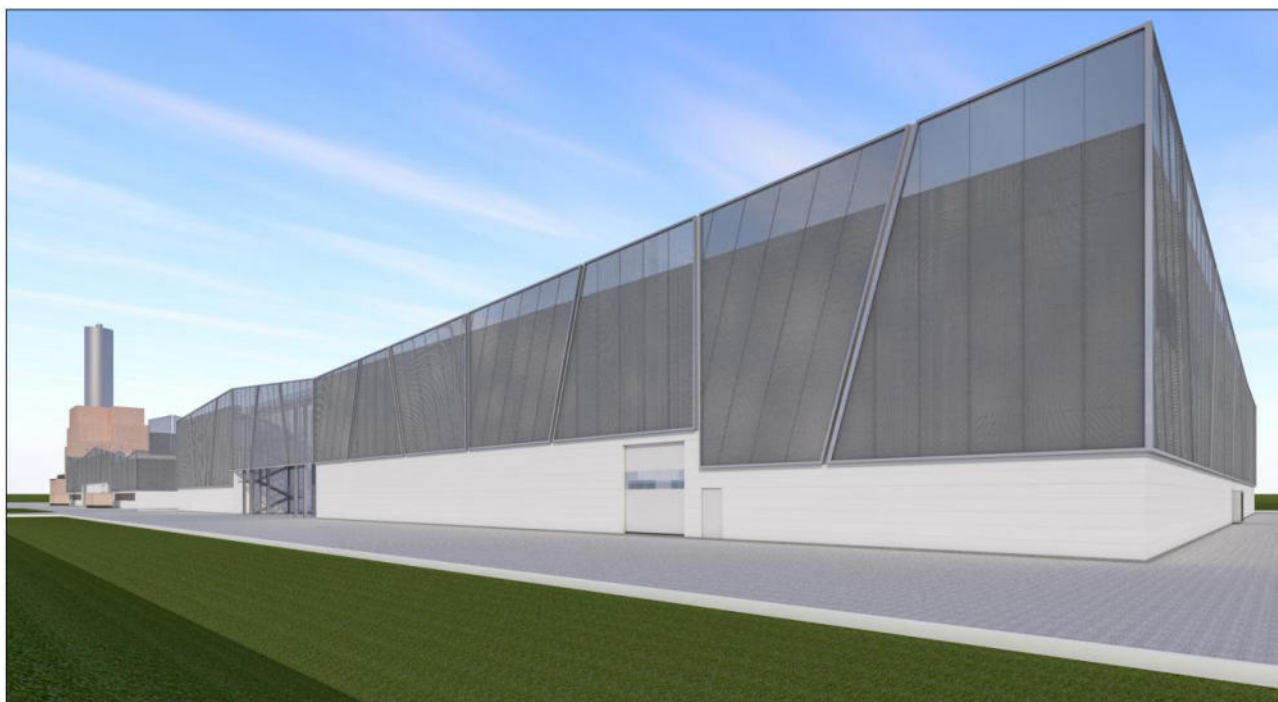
Estratto prospetti di progetto (Tav. A.15).
